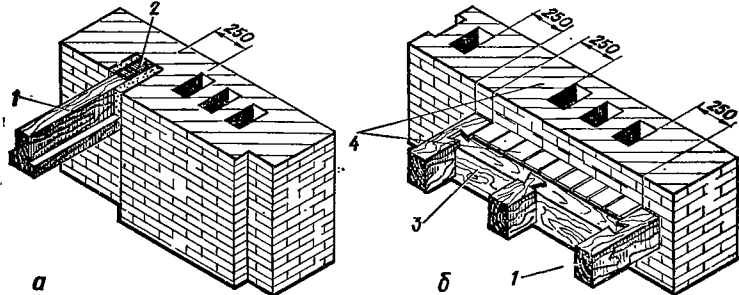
Крепление деревянных балок возле дымовых каналов:
